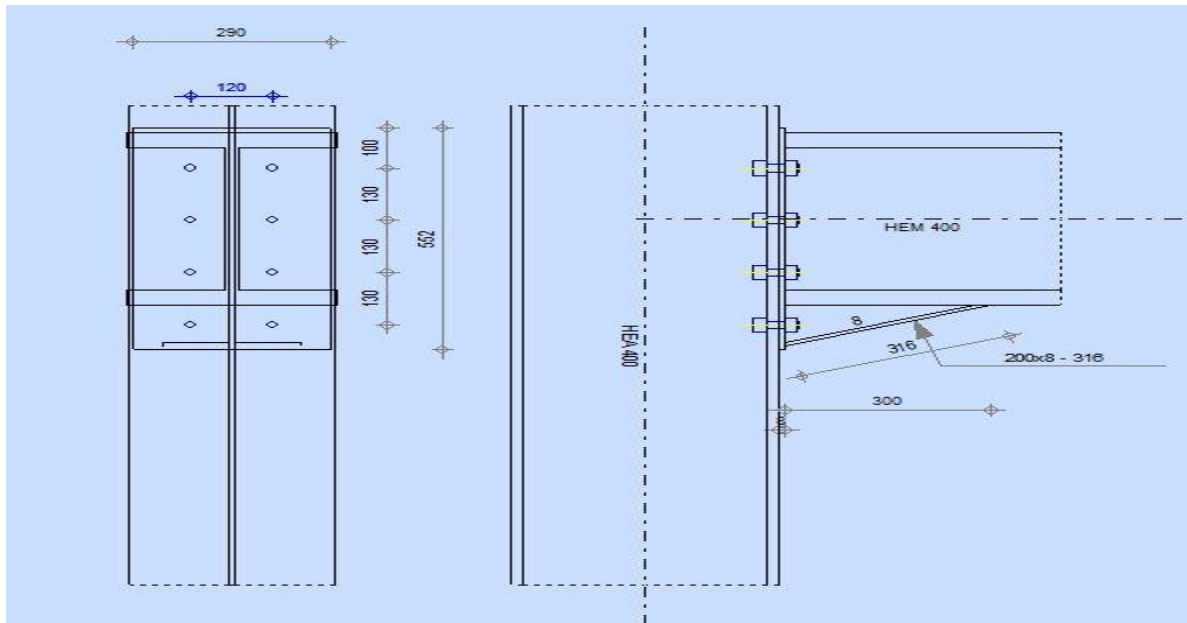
Détail sur l'assemblage poutre support du pont roulant poteau.
